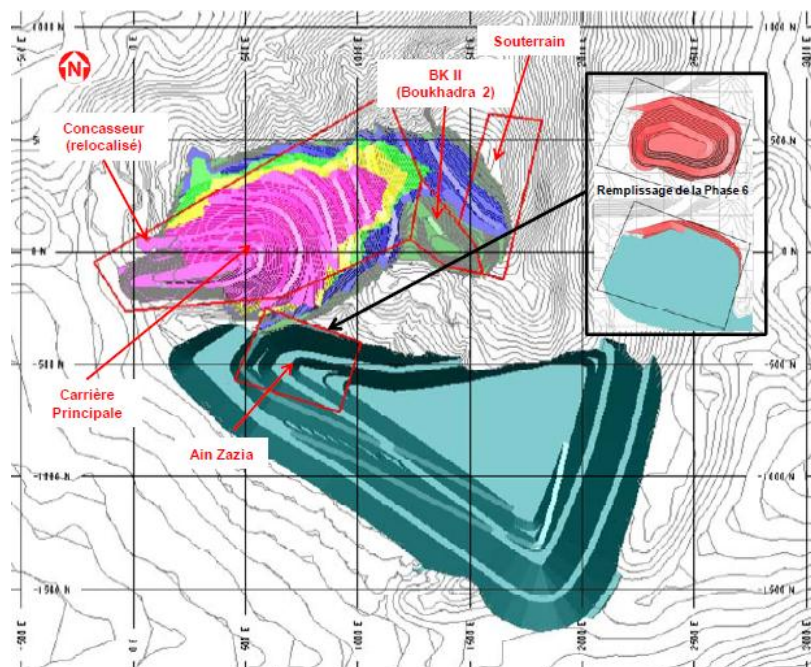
Plan général de Boukhadra (Amec 2011)
